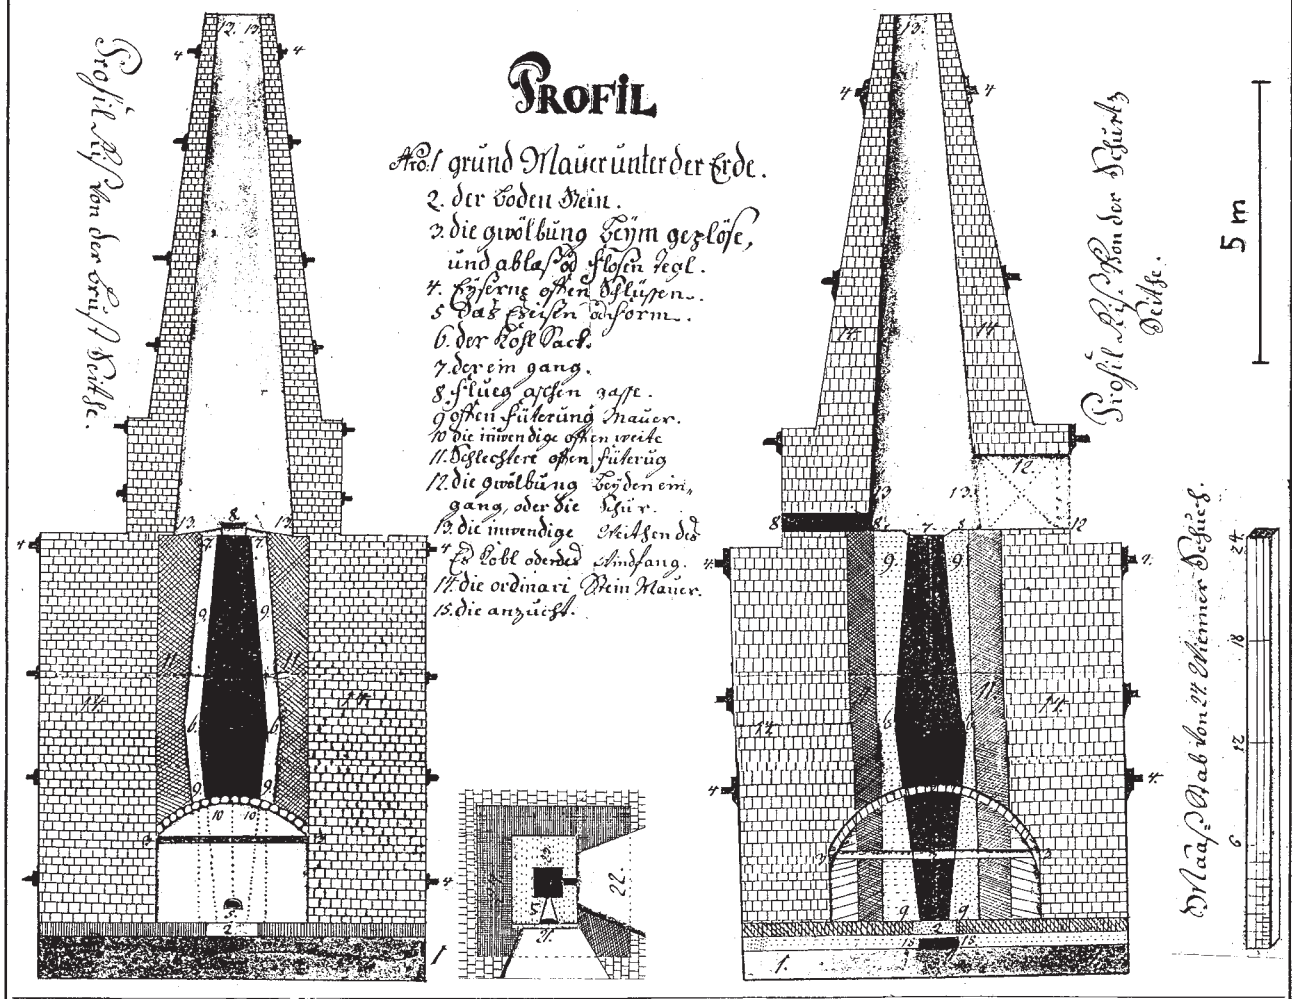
Flossofen („Plaaoffen“) in Turrach, Längsschnitte und Grundriss; um 1750. Plan (Ausschnitt) in den Schwarzenbergischen Archiven Murau.
